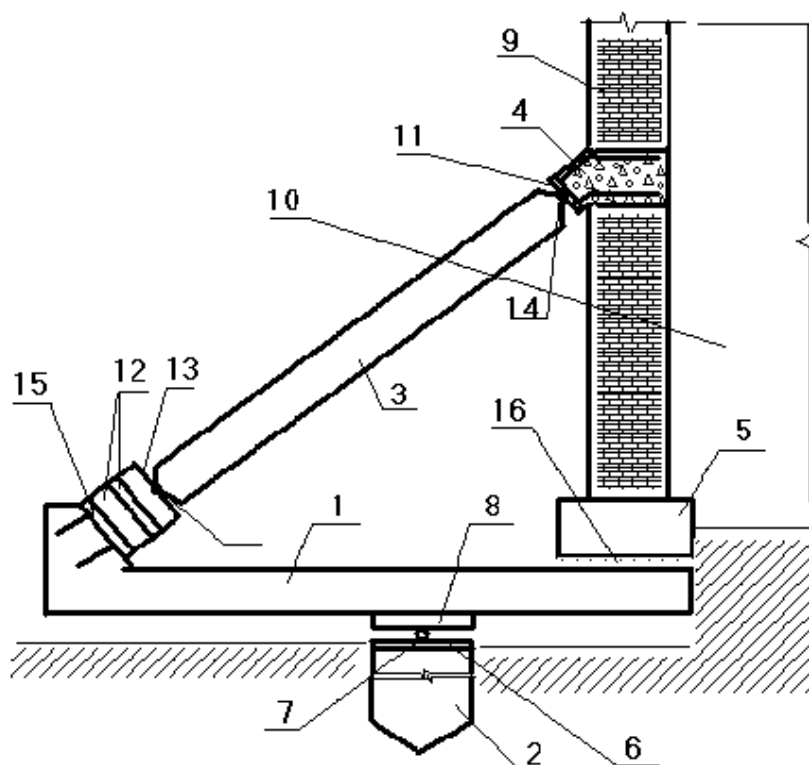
Схема усиления фундамента предварительно напряженным подкосом.
